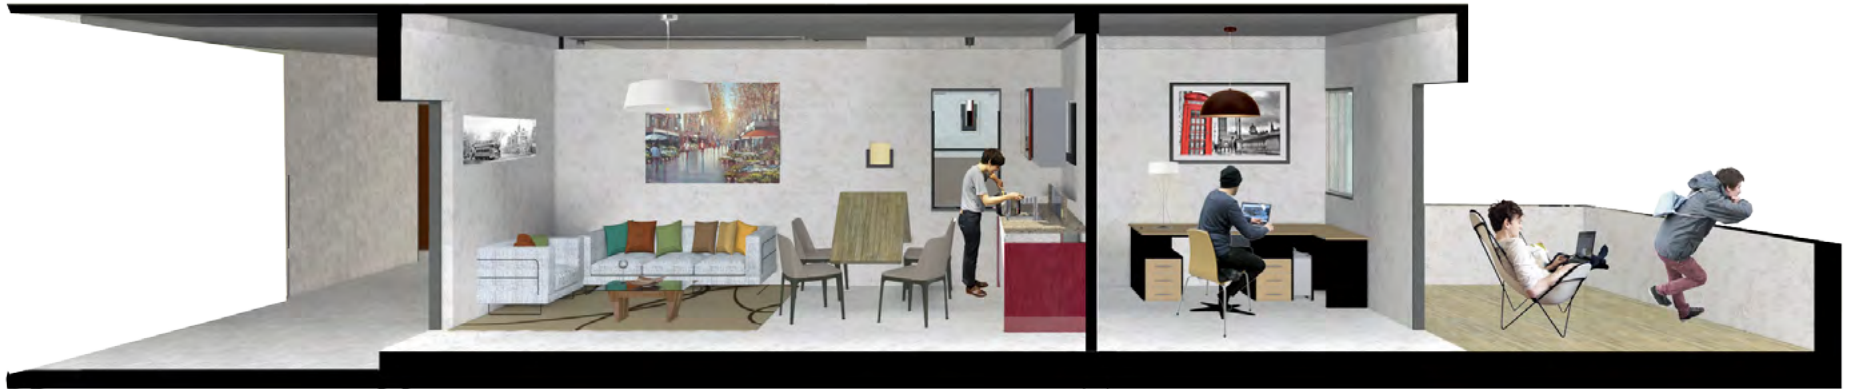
Corte Perspectivado de Módulo de vivienda
